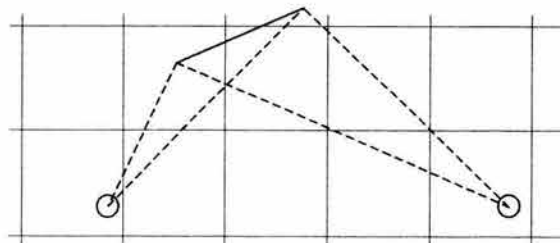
Ubicación en la planimetría de los puntos principales 1 y 2.
